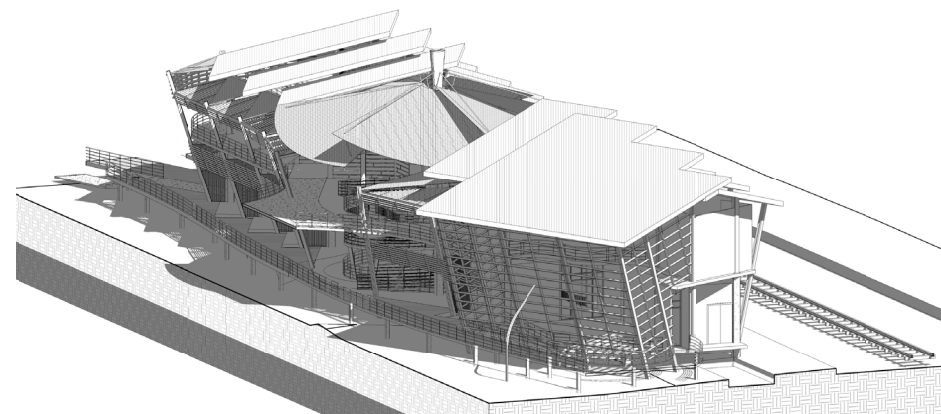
Asoleamiento en la fachada sureste - Marzo 9am.
